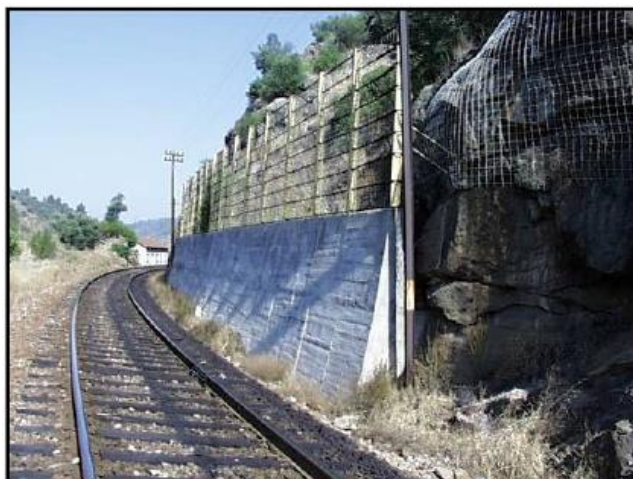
Barreira metálica rígida na Linha da Beira Baixa (Teixeira, 2009)
